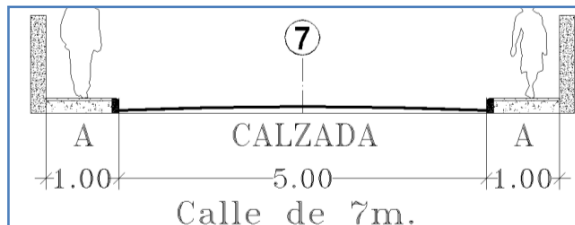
Sección tipo prevista en las NNSS'99 para una vía de 7 metros.
